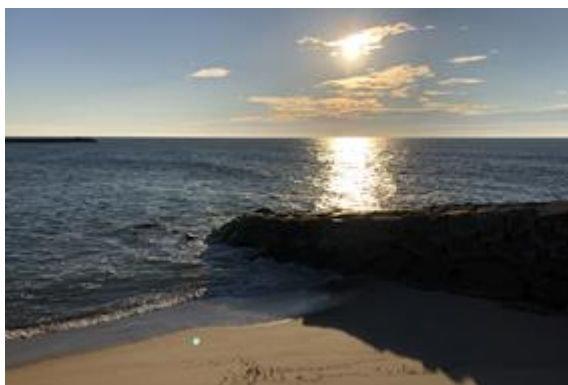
Fotografia da zona colapsada da proteção aderente.
